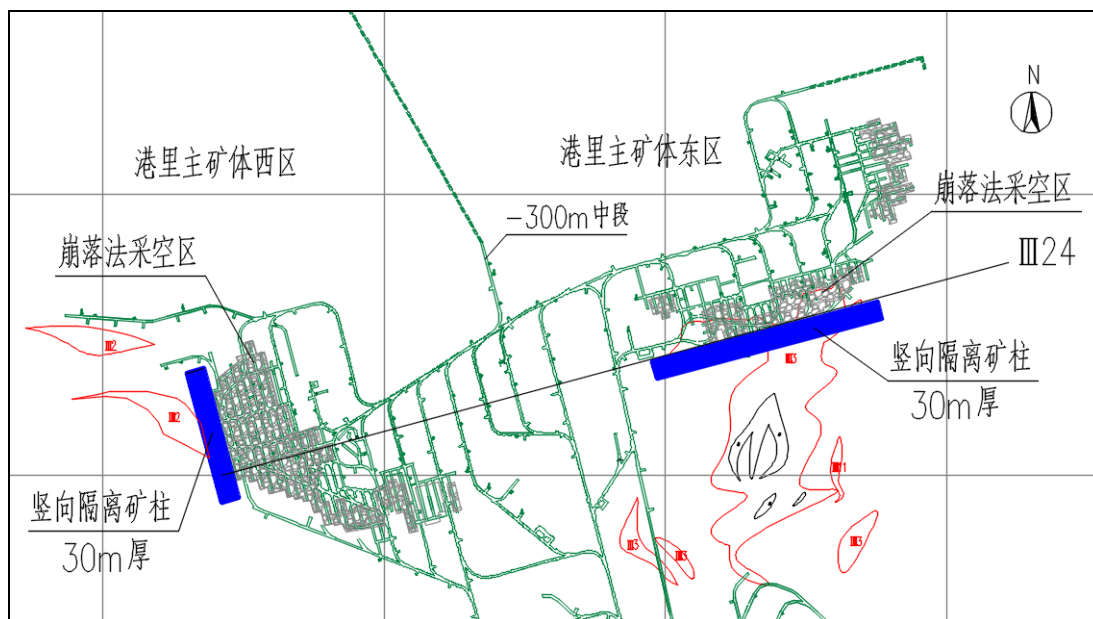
300m 中段崩落法竖向隔离矿柱平面图
